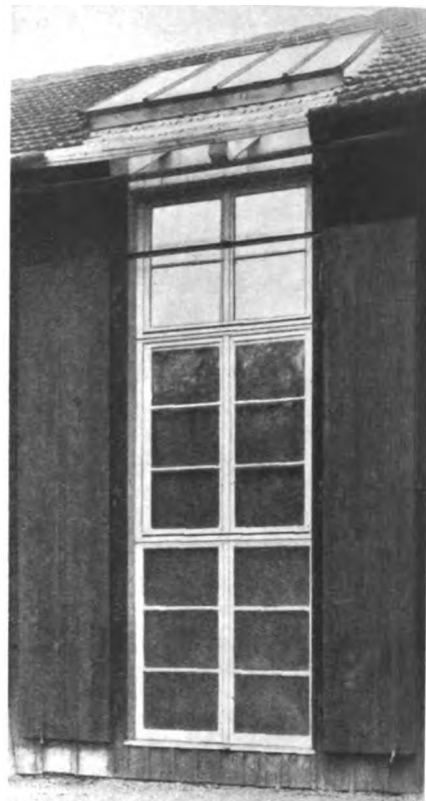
Fenster und Oberlicht; dahinter Rolladen mit Fensterausschnitt.
